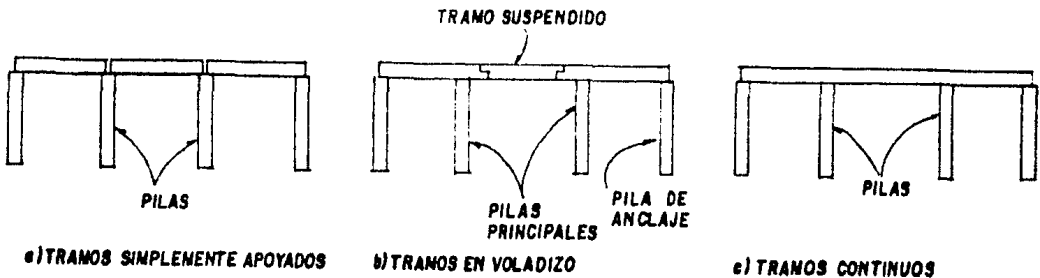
Disposición estructural de los miembros principales de carga de un puente.
